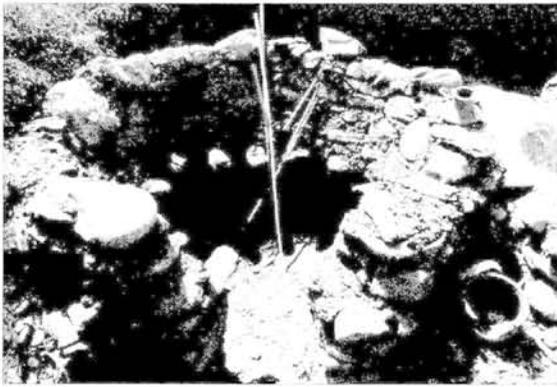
Souk Sept M'zouda. Four en construction : on aperçoit les corbeaux de pierre pour le support de la soie
